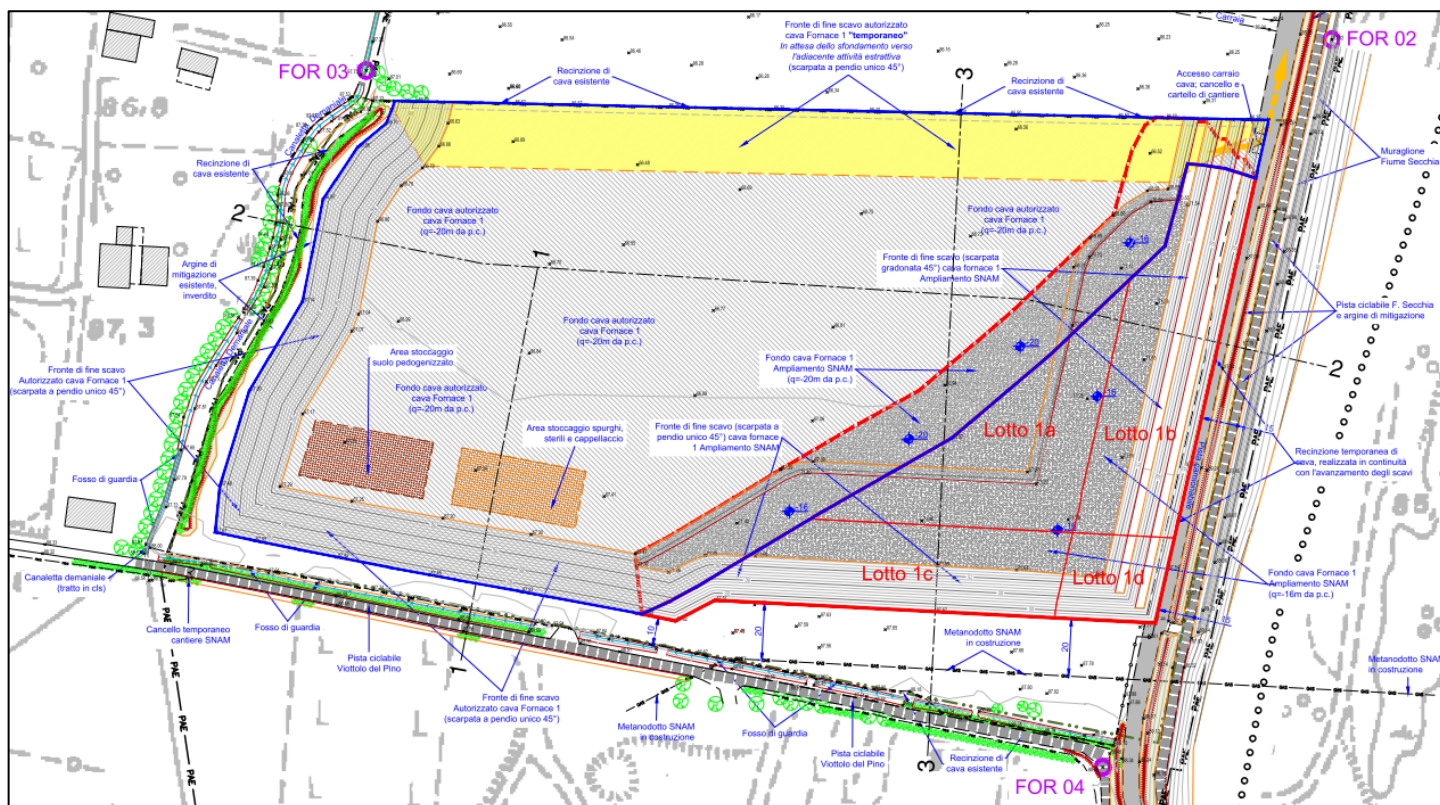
Stralcio Tav. 07 – "Progetto - Planimetria di massimo scavo".
